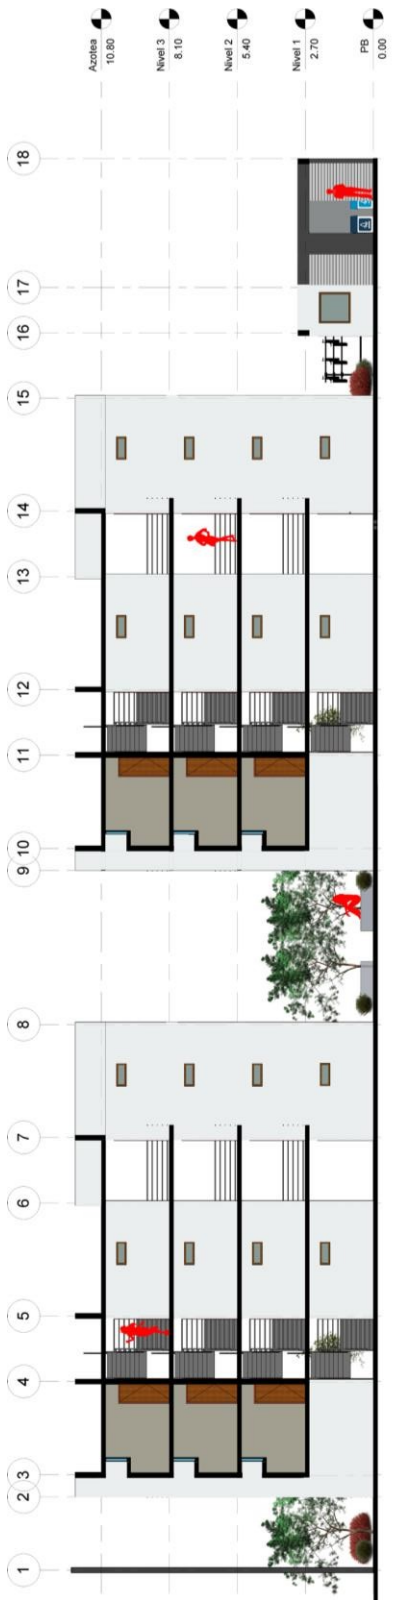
Sección Esquemática, cara Oeste. Sin escala. Fuente: Elaboración propia
